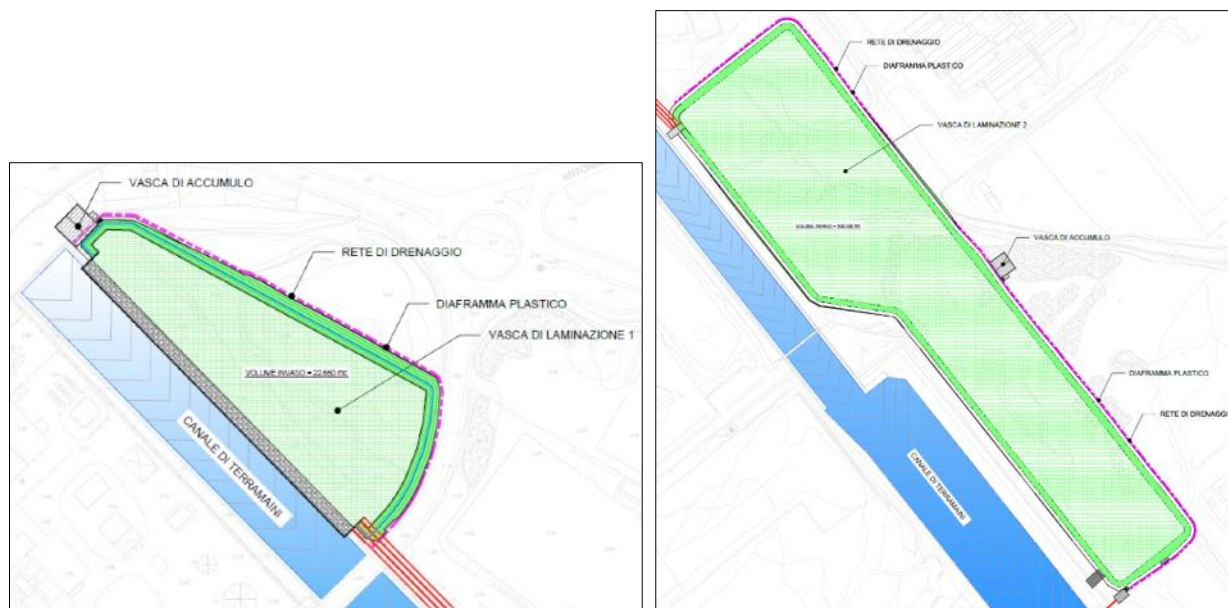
Planimetria della rete perimetrale di drenaggio. A sinistra rete dell'invaso n. 1, a destra rete dell'invaso n.2.
